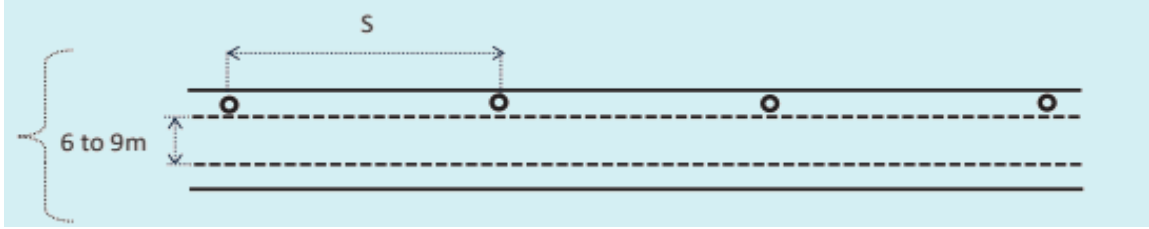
सिंगल साइडेड अ‍ॅरेंजमेंट (Single sided arrangement)
